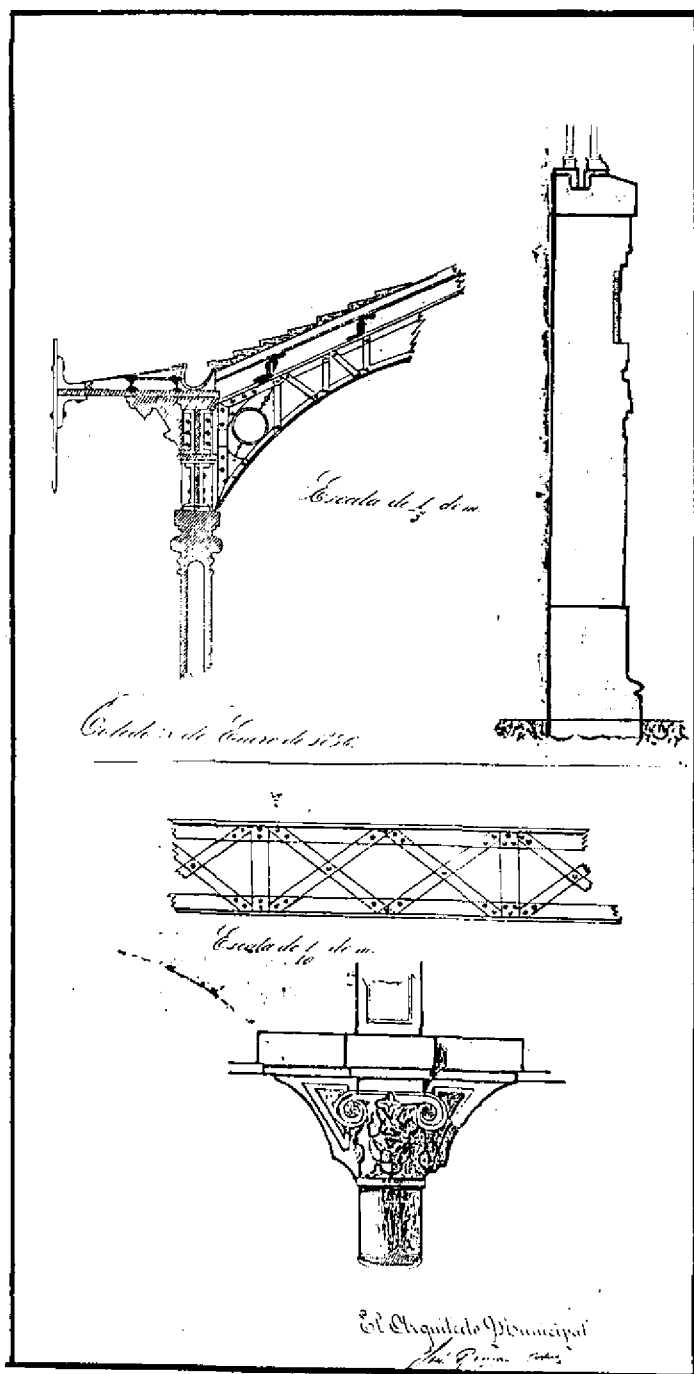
Detalles de perfiles y soportes del proyecto de 1896. (A.M.I.).
